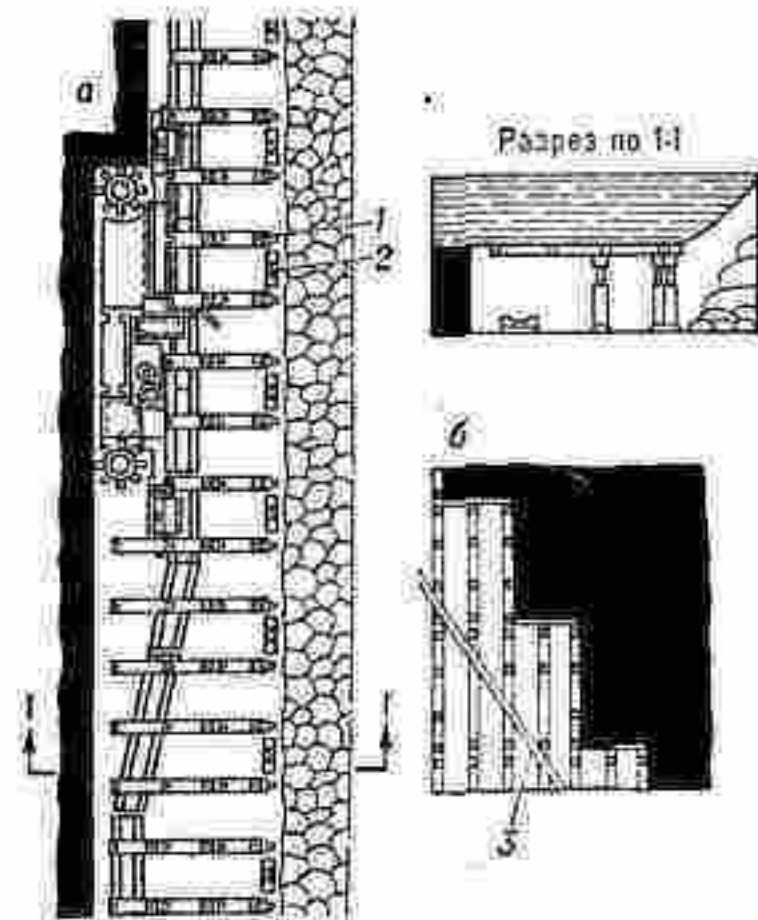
Крепление очистного забоя (лавы) индивидуальной крепью: а — на пологом пласте; б — на крутопадающем пласте; 1 — металлич. стойка; 2 — металлическая посадочная стойка (тумба); 3 — углеспускной решётак.
